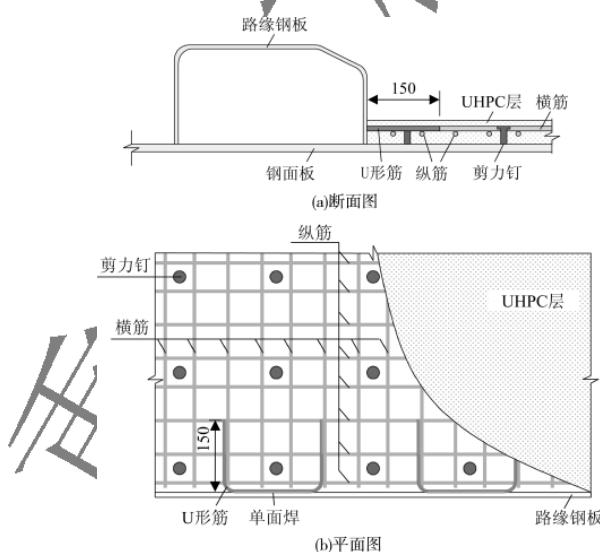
焊接 U 形钢筋的超高性能混凝土-钢
